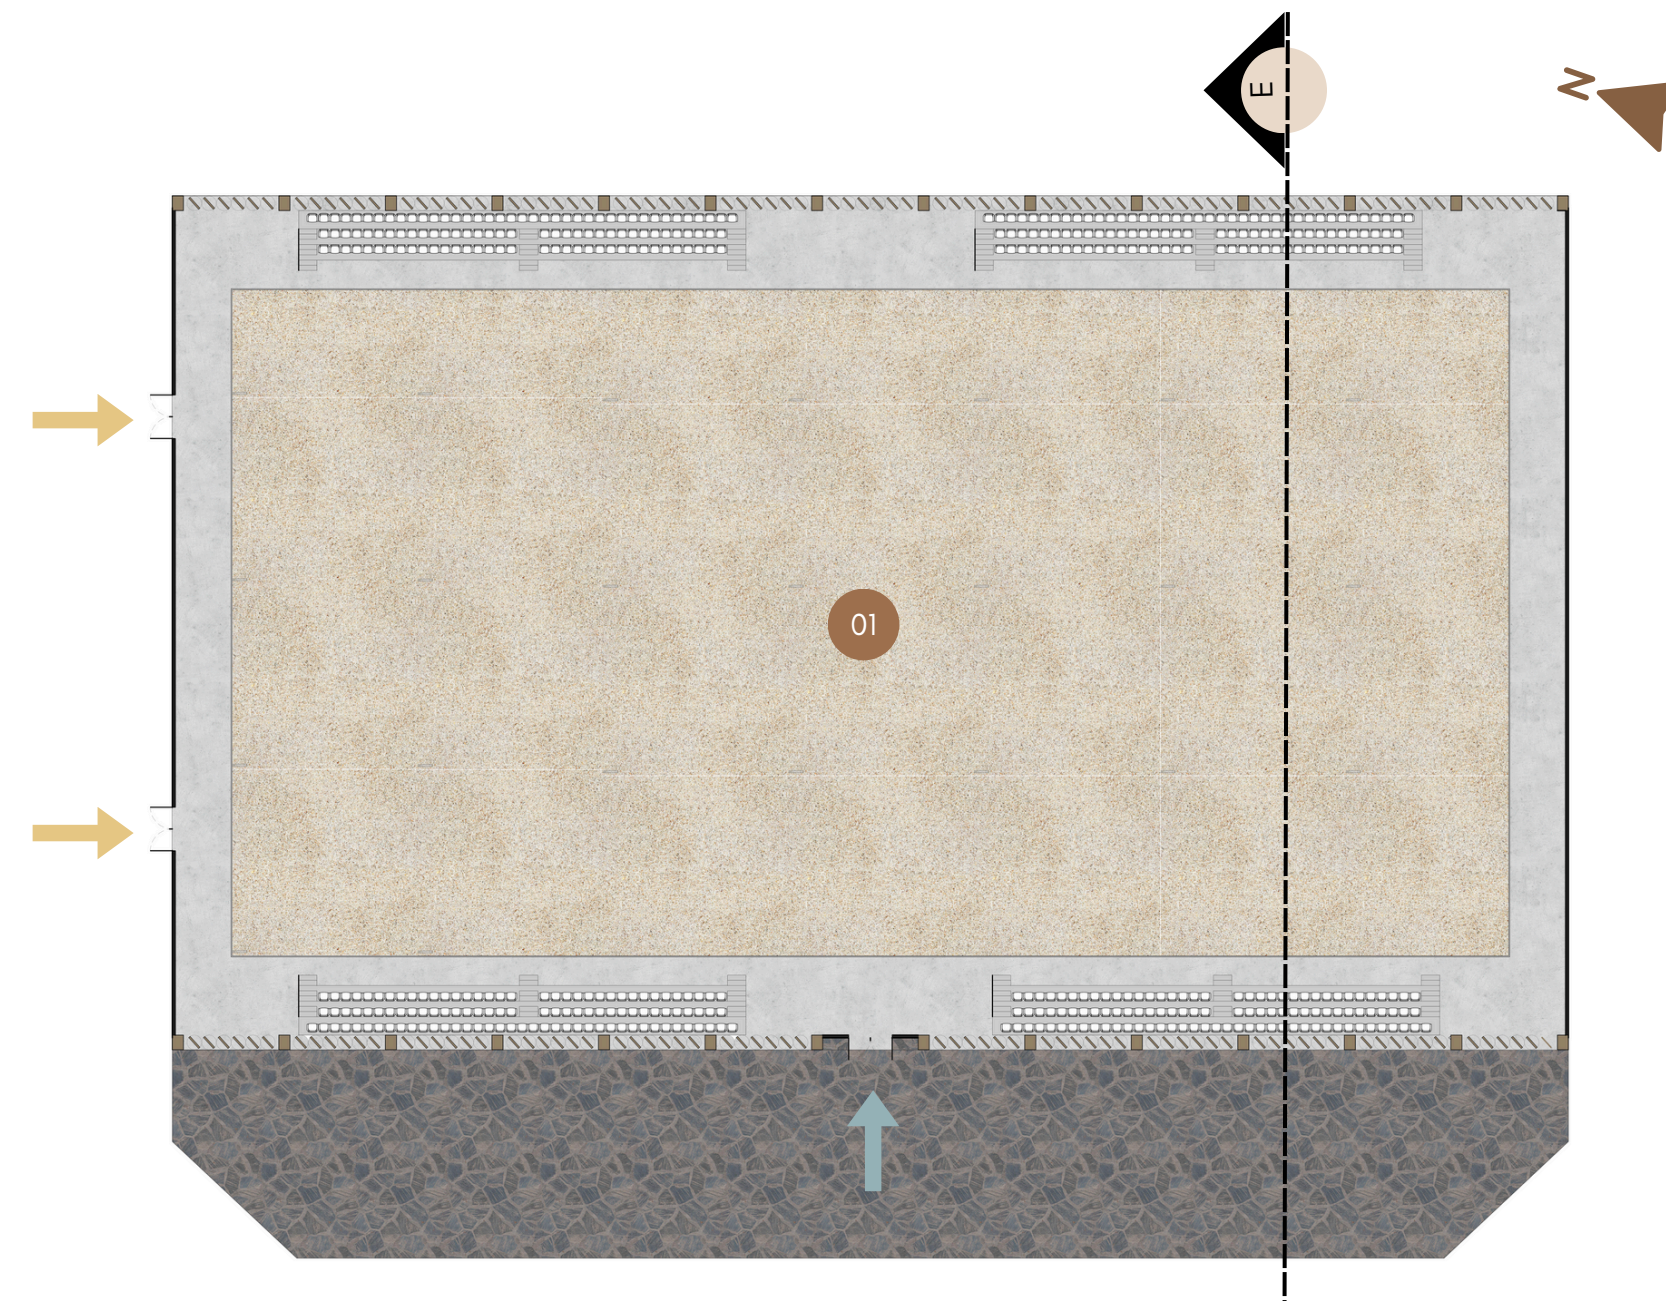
Planta baixa Picadeiro Provas / Fonte: Elaborado pela autora em 2024
